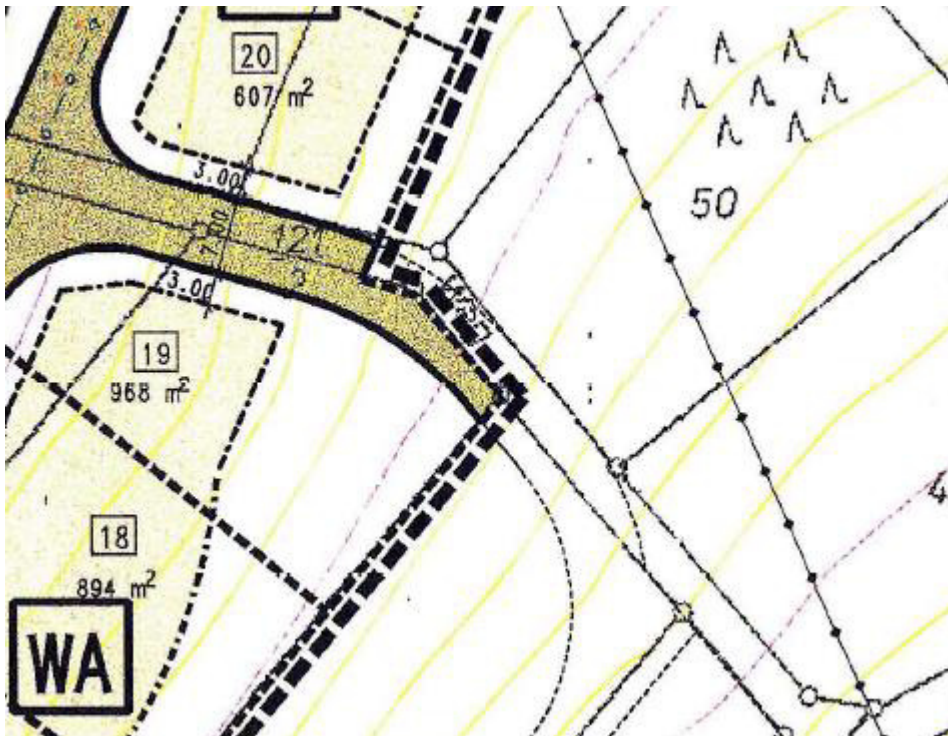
Ausschnitt B-Plan „Am Holzapfelbaum II“ Nordost
